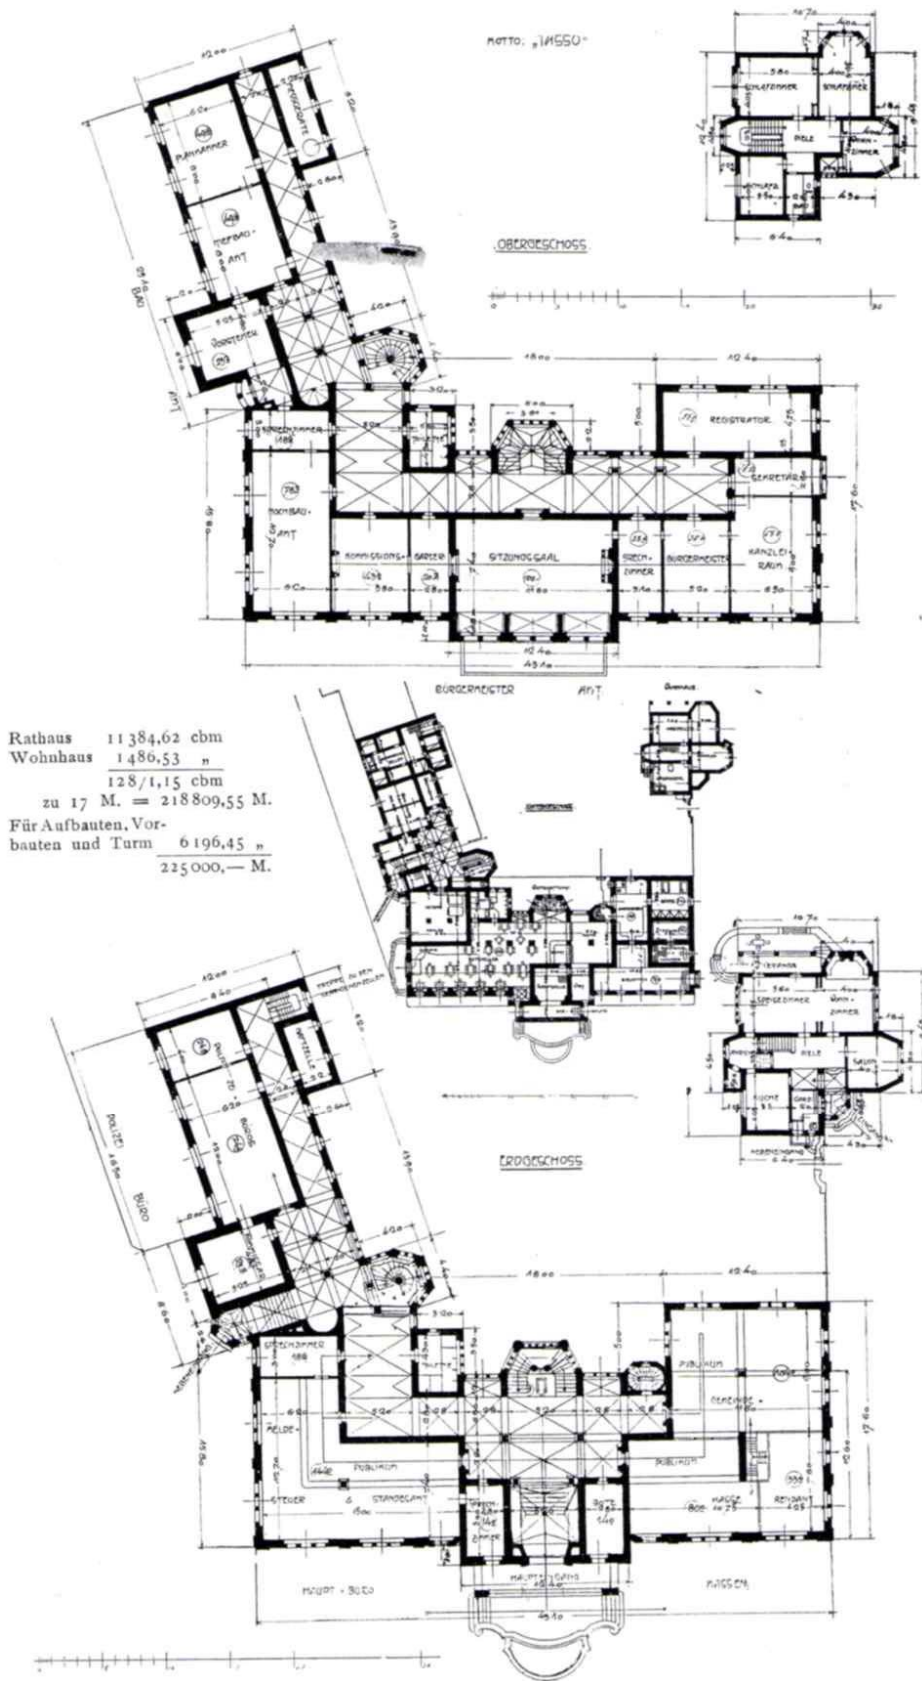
Grundrisse zum WB-Entwurf Rathaus Wiesdorf, 1907 – Arch.: Walter Furthmann
